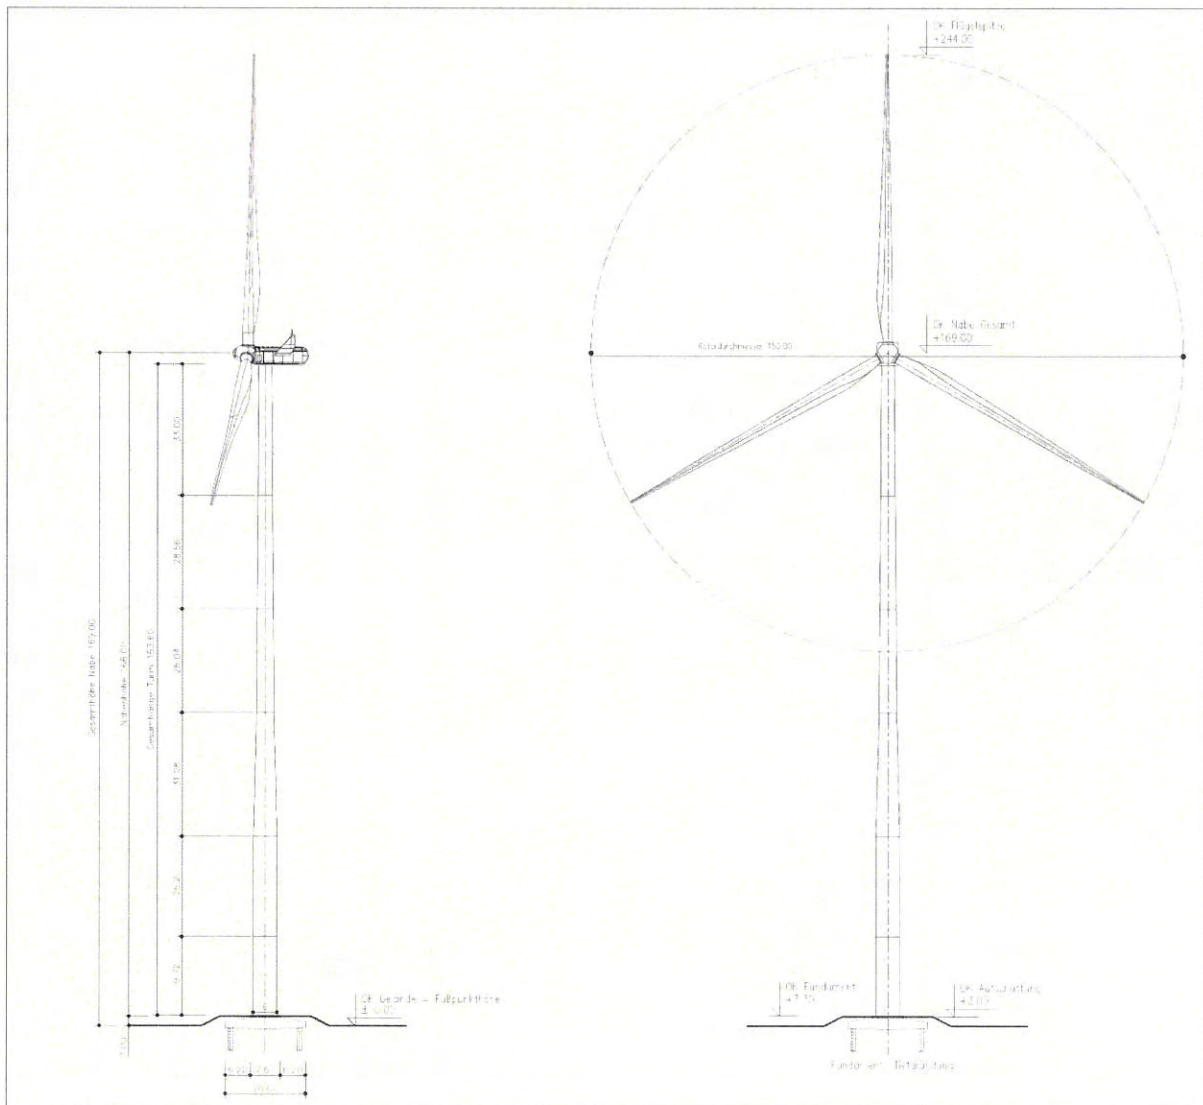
Plandarstellung Vestas V150-4,2 MW mit Nabenhöhe 169 m
